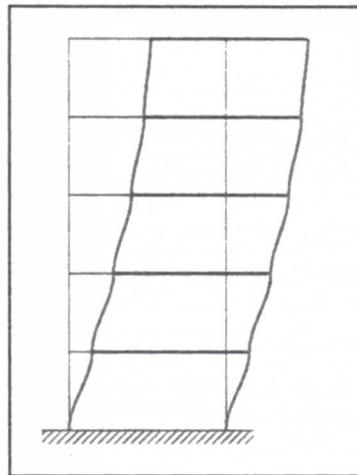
Comportamiento estructural de un edificio con vigas infinitamente rígidas
